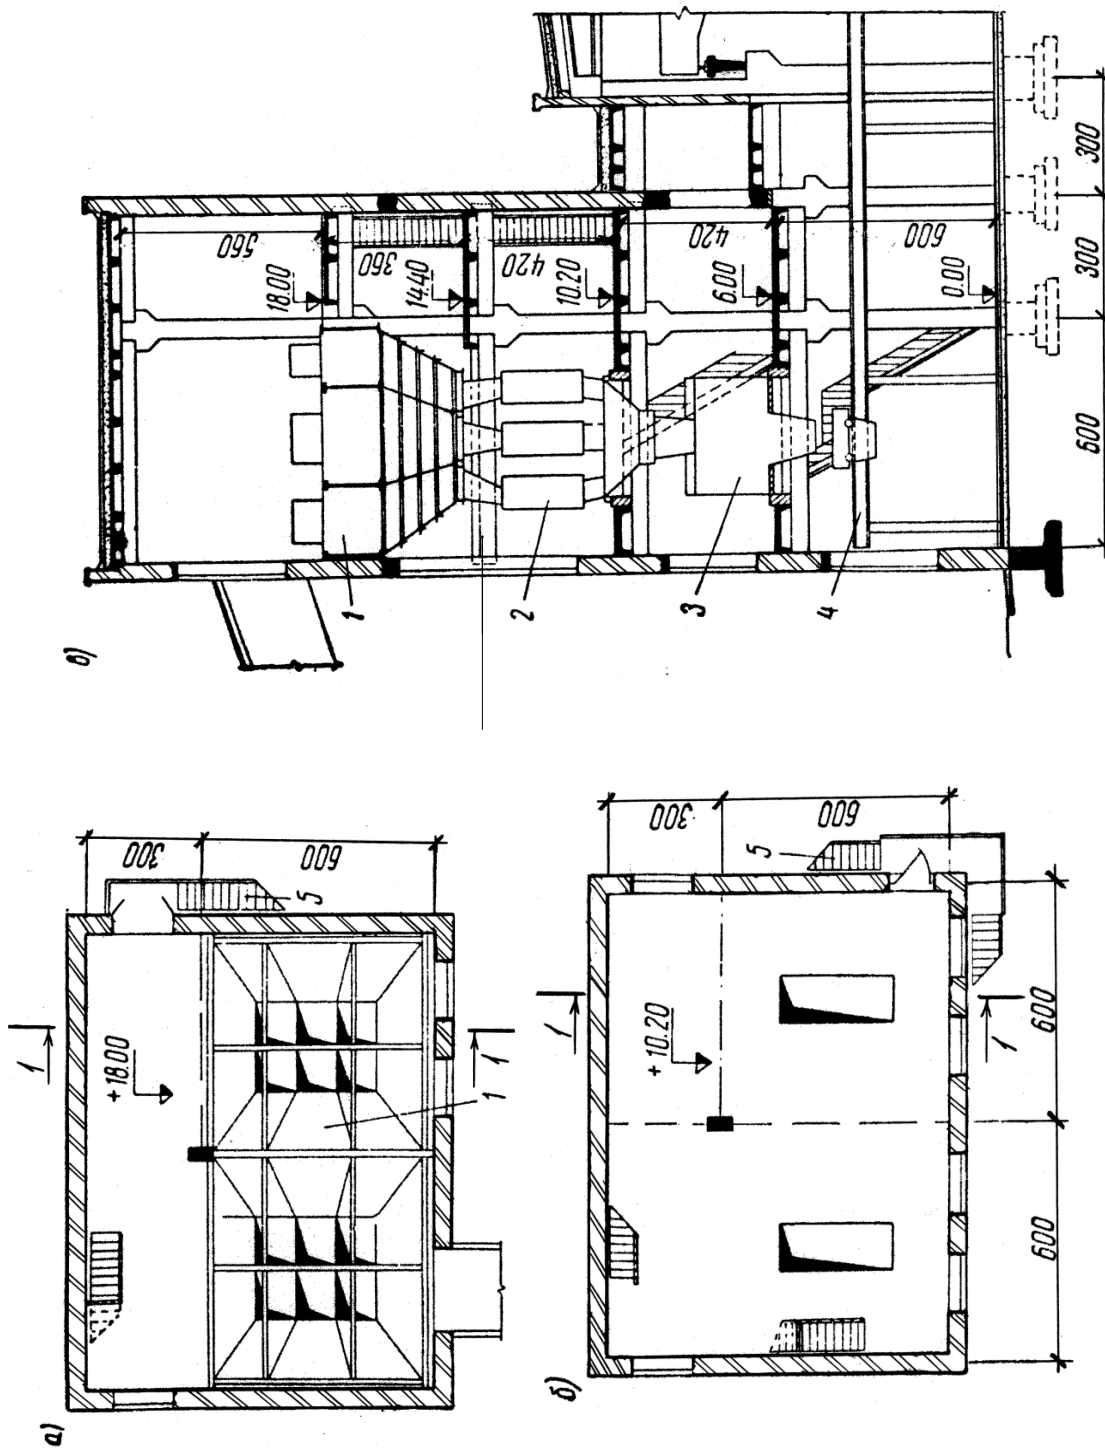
Бетоносмесительный цех завода железобетонных изделий: а) план надбункерного отделения на отметке +18,000; б) план дозирочного отделения на отметке +10,200; в) поперечный разрез по 1—1; 1 — стальные бункера для заполнителей и цемента; 2 — весовые дозаторы; 3 — бетономешалка; 4 — эстакада для подачи бетона в формовочный цех; 5 — металлическая пожарная лестница
